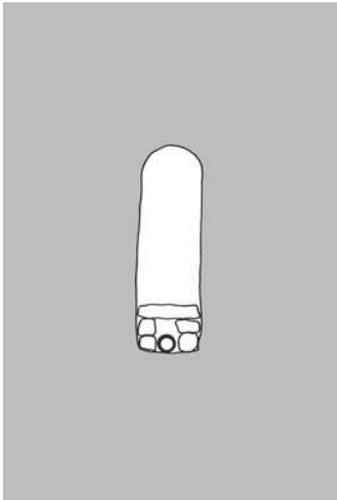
Profil 3. Schnitt durch den Kanaleinbau mit Tonrohrleitung in Baulos 23. M. 1:50.
